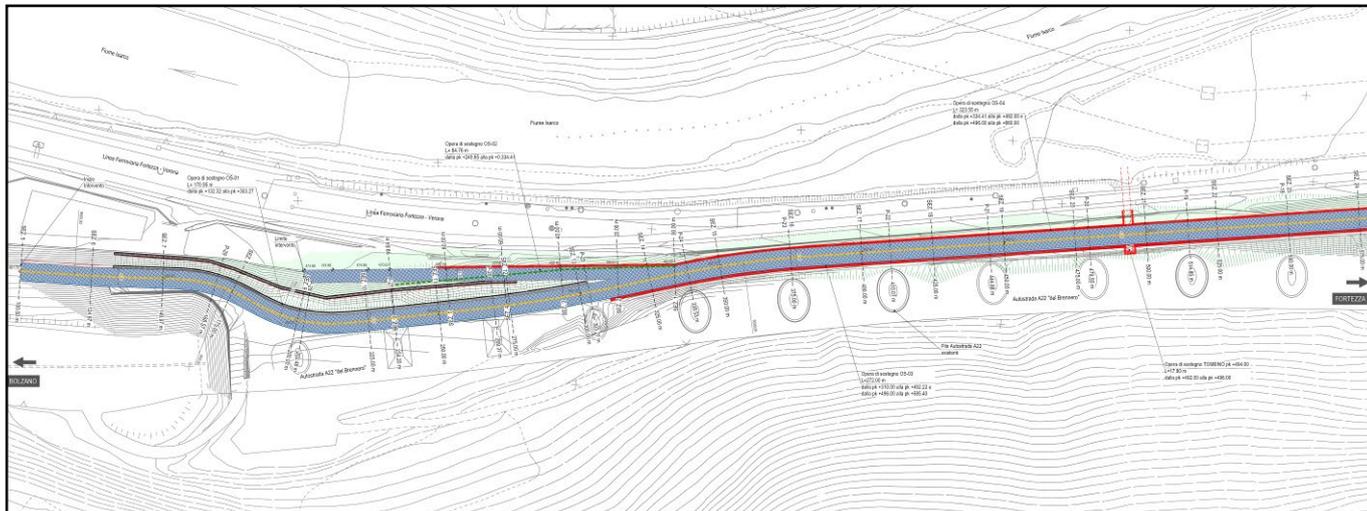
Planimetria di progetto (tra le progressive 0+100.00 m e 0+575.00 m)
